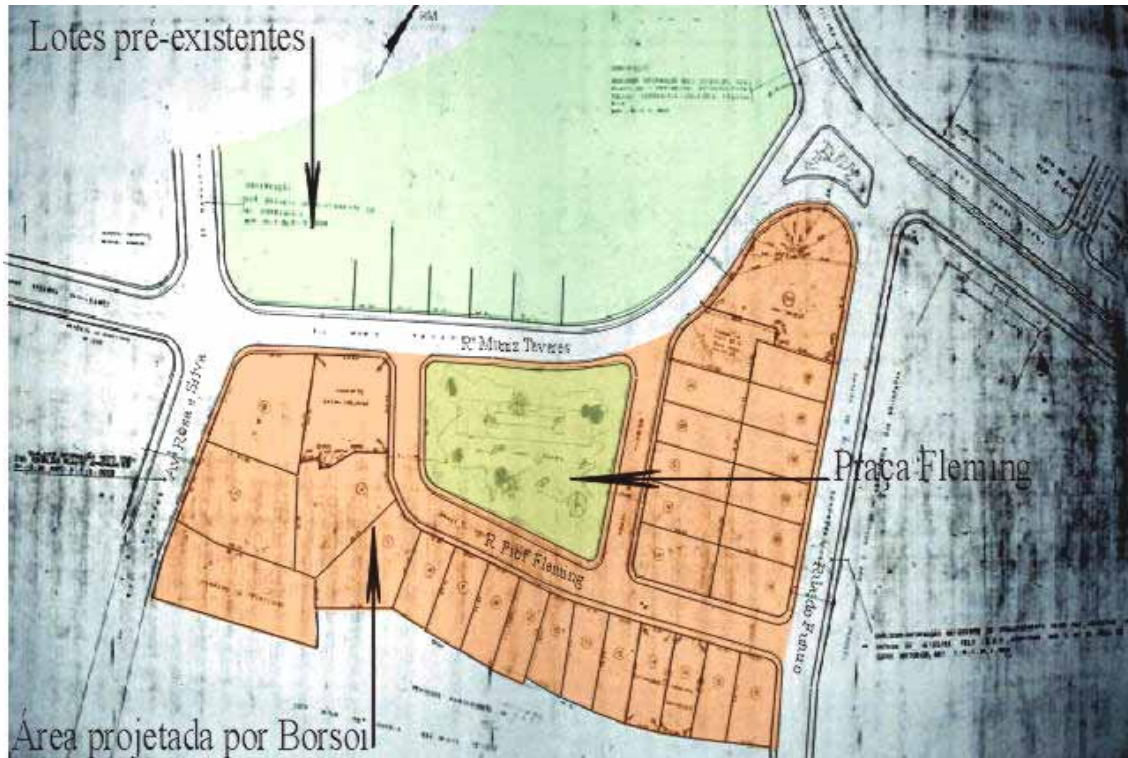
Planta do loteamento Banco Lar Brasileiro. Fonte: Dircon
